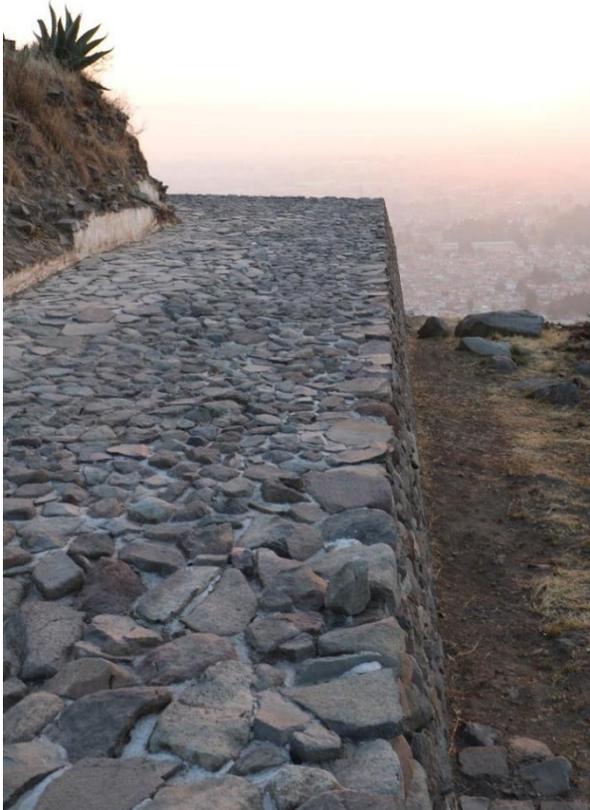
A la izquierda el muro sur de la Estructura 1. Al centro el descanso sur de la Estructura 1.
